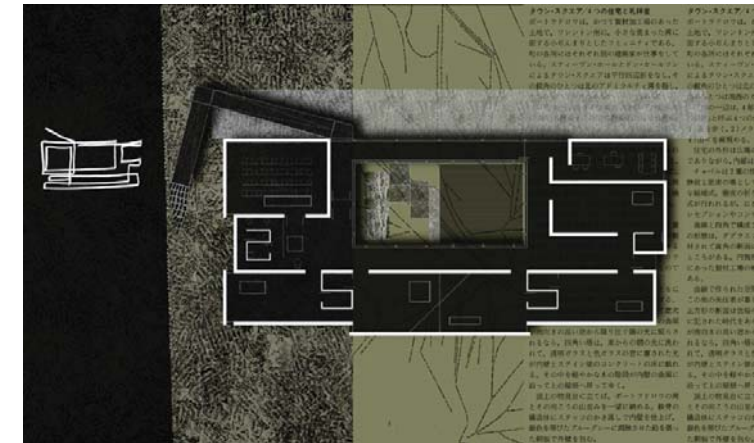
Lámina planta baja. Fuente: plataformaarquitectura.cl
